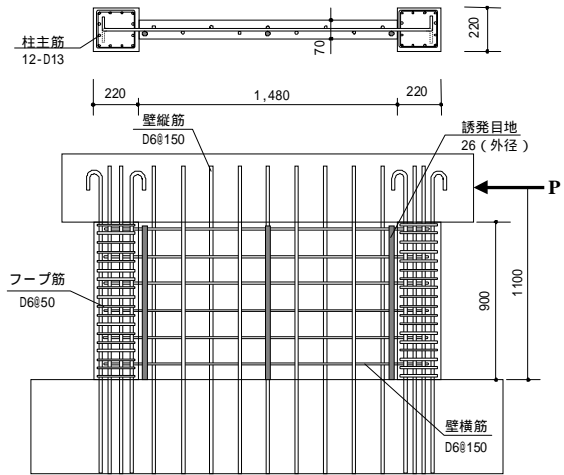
耐震壁試験体の状況 (No.1) Structural Wall-Specimen Form (No.1)
